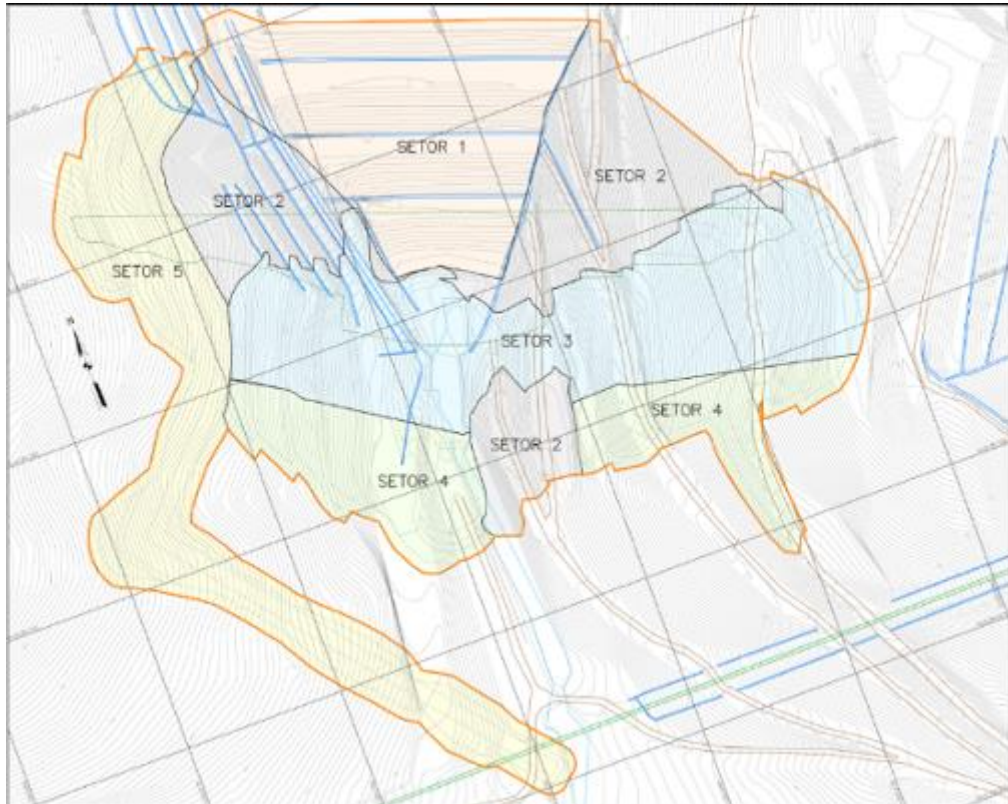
Setorização da fundação para limpeza e escavação (9002SA-X-70287)
